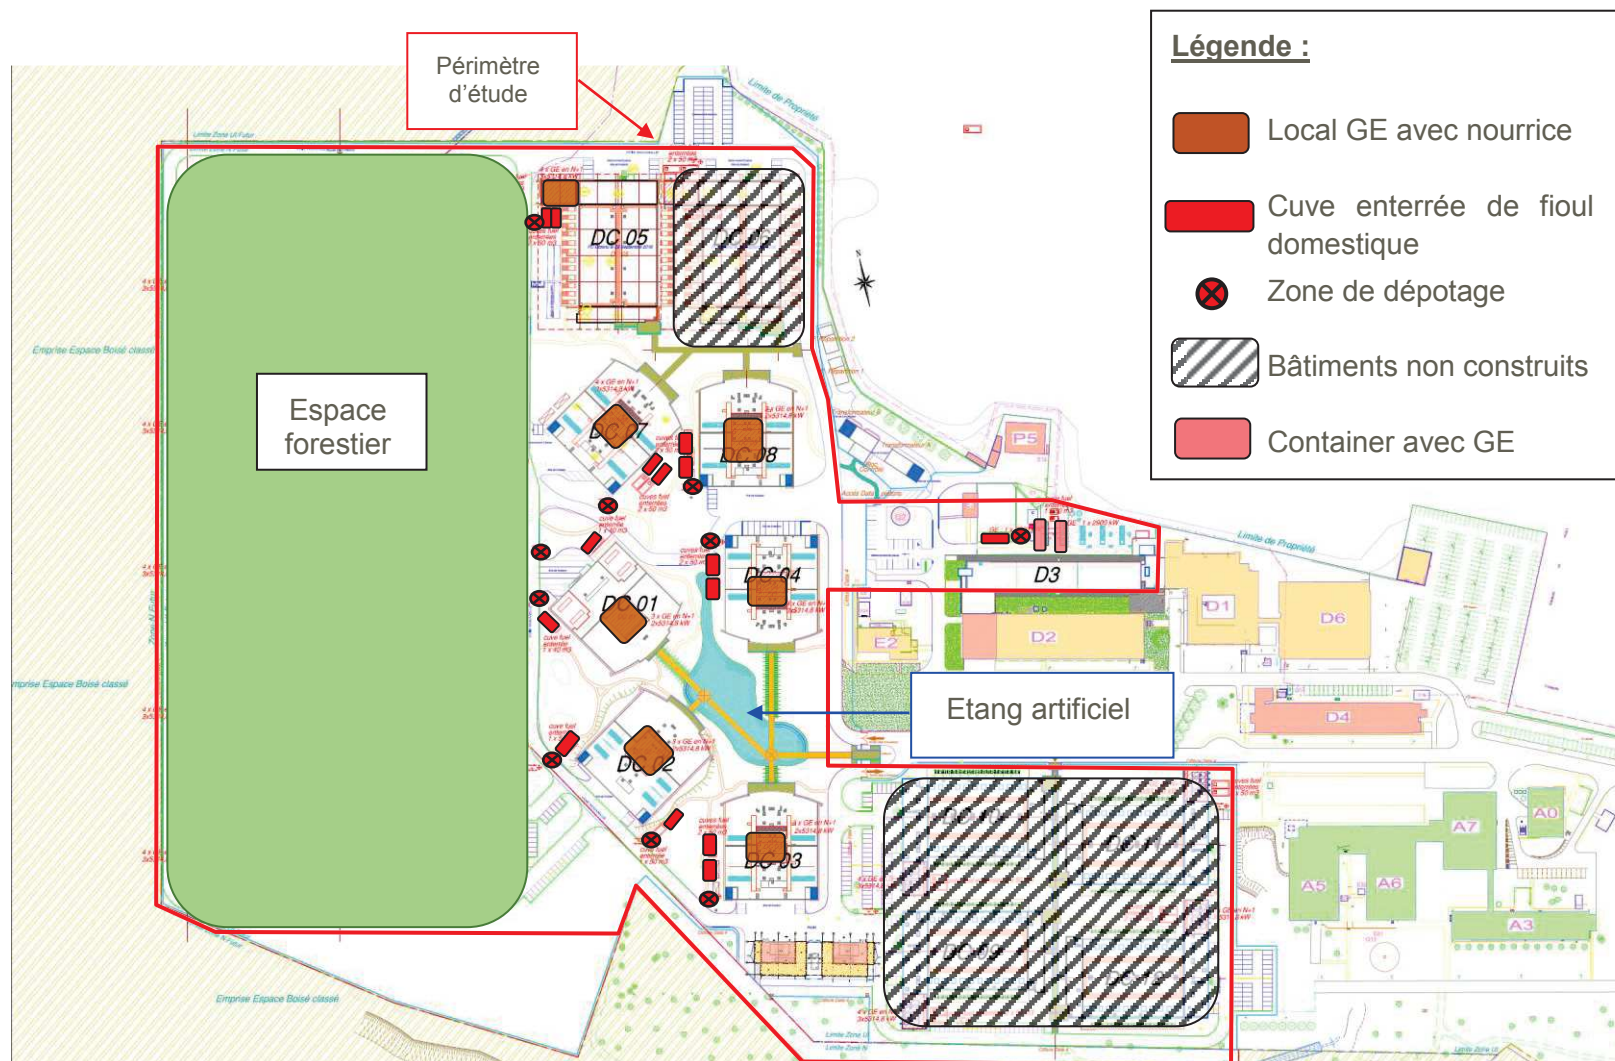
Configuration actuelle du site (sur fond de plan source client)
